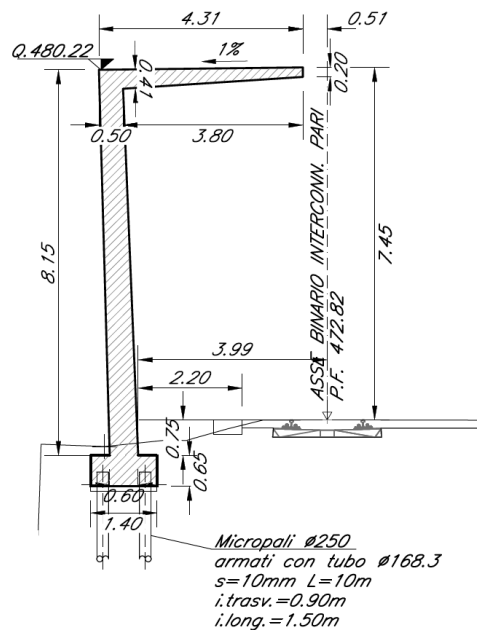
sezione muri lungo linea (zona 1 e zona 2)
